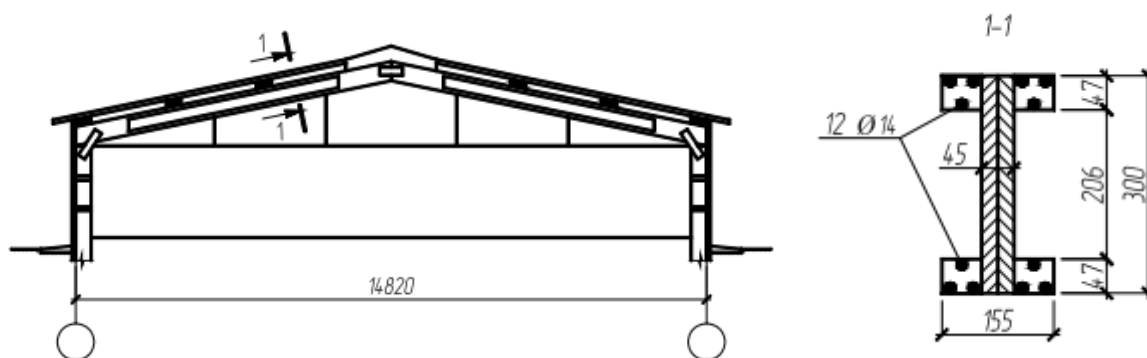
Клееная армированная треугольная арка в покрытии производственного здания (Швеция)
